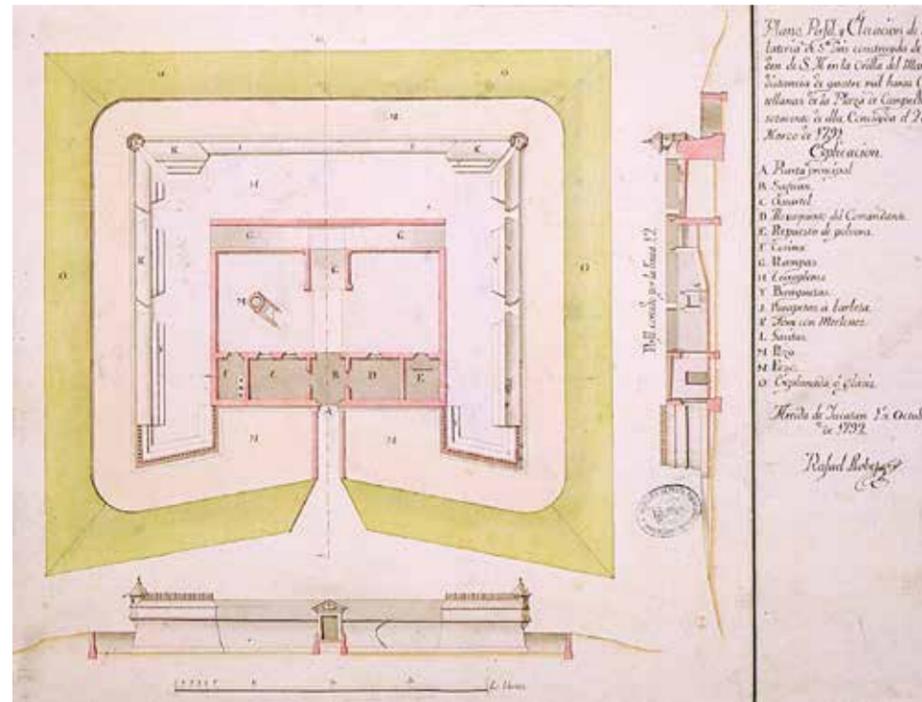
Plano de la Batería de San Luis por el Ing. Rafael Llobet, 1792.
